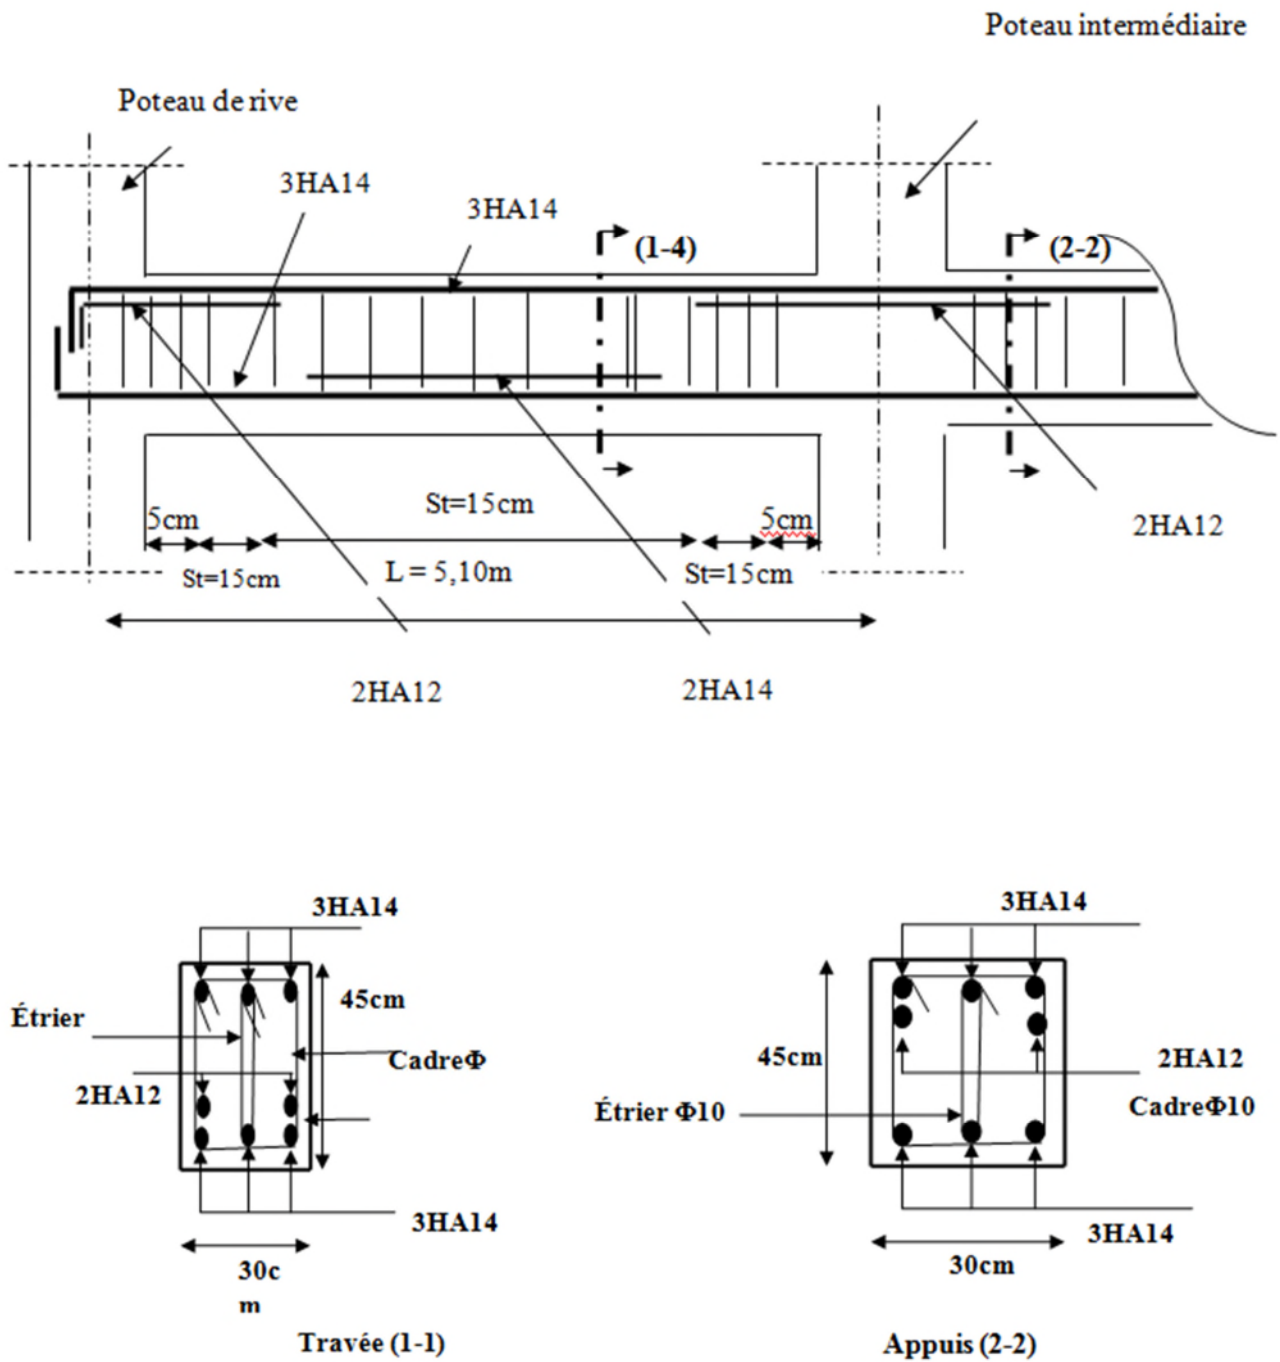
Schéma de ferrailage de la poutre principale (30*45) du 2^{ème} au 9^{ème} étage + terrasse inaccessible.
